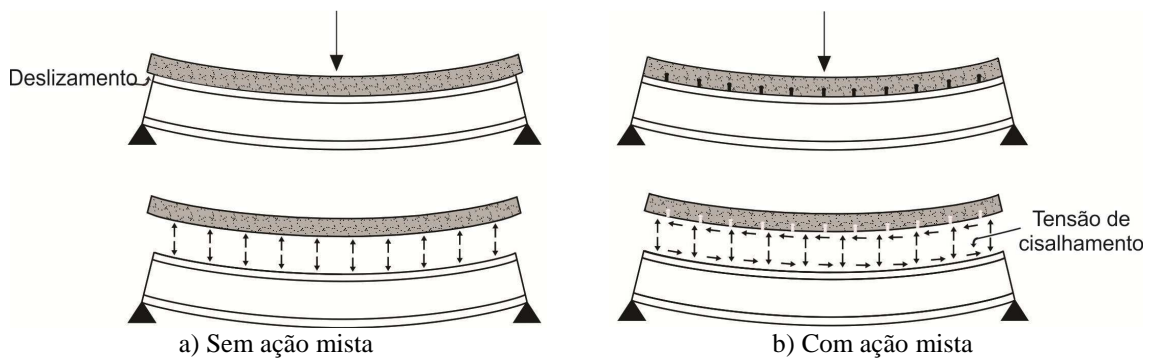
Vigas mistas fletidas (adaptado de David, 2007).
